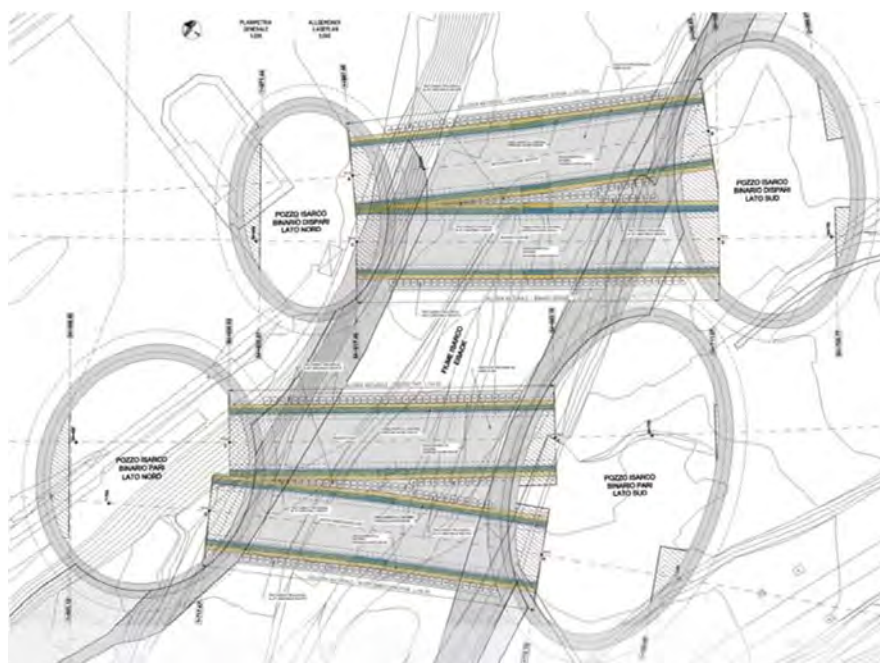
Schema planimetrico delle gallerie di sottoattraversamento del fiume Isarco
